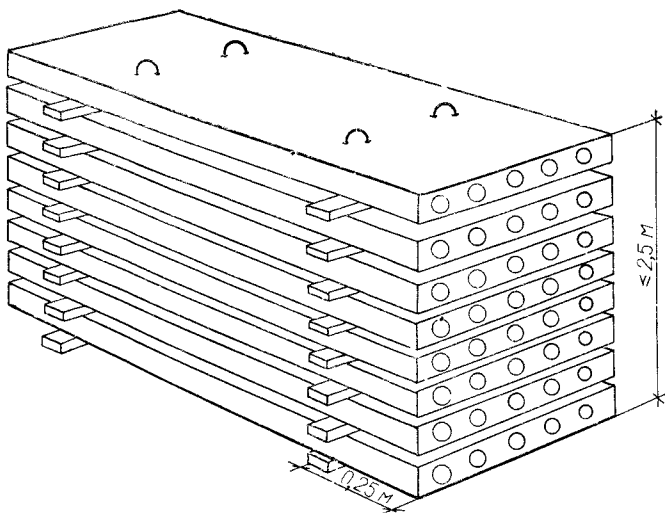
Плиты перекрытий на подкладках и прокладках.
